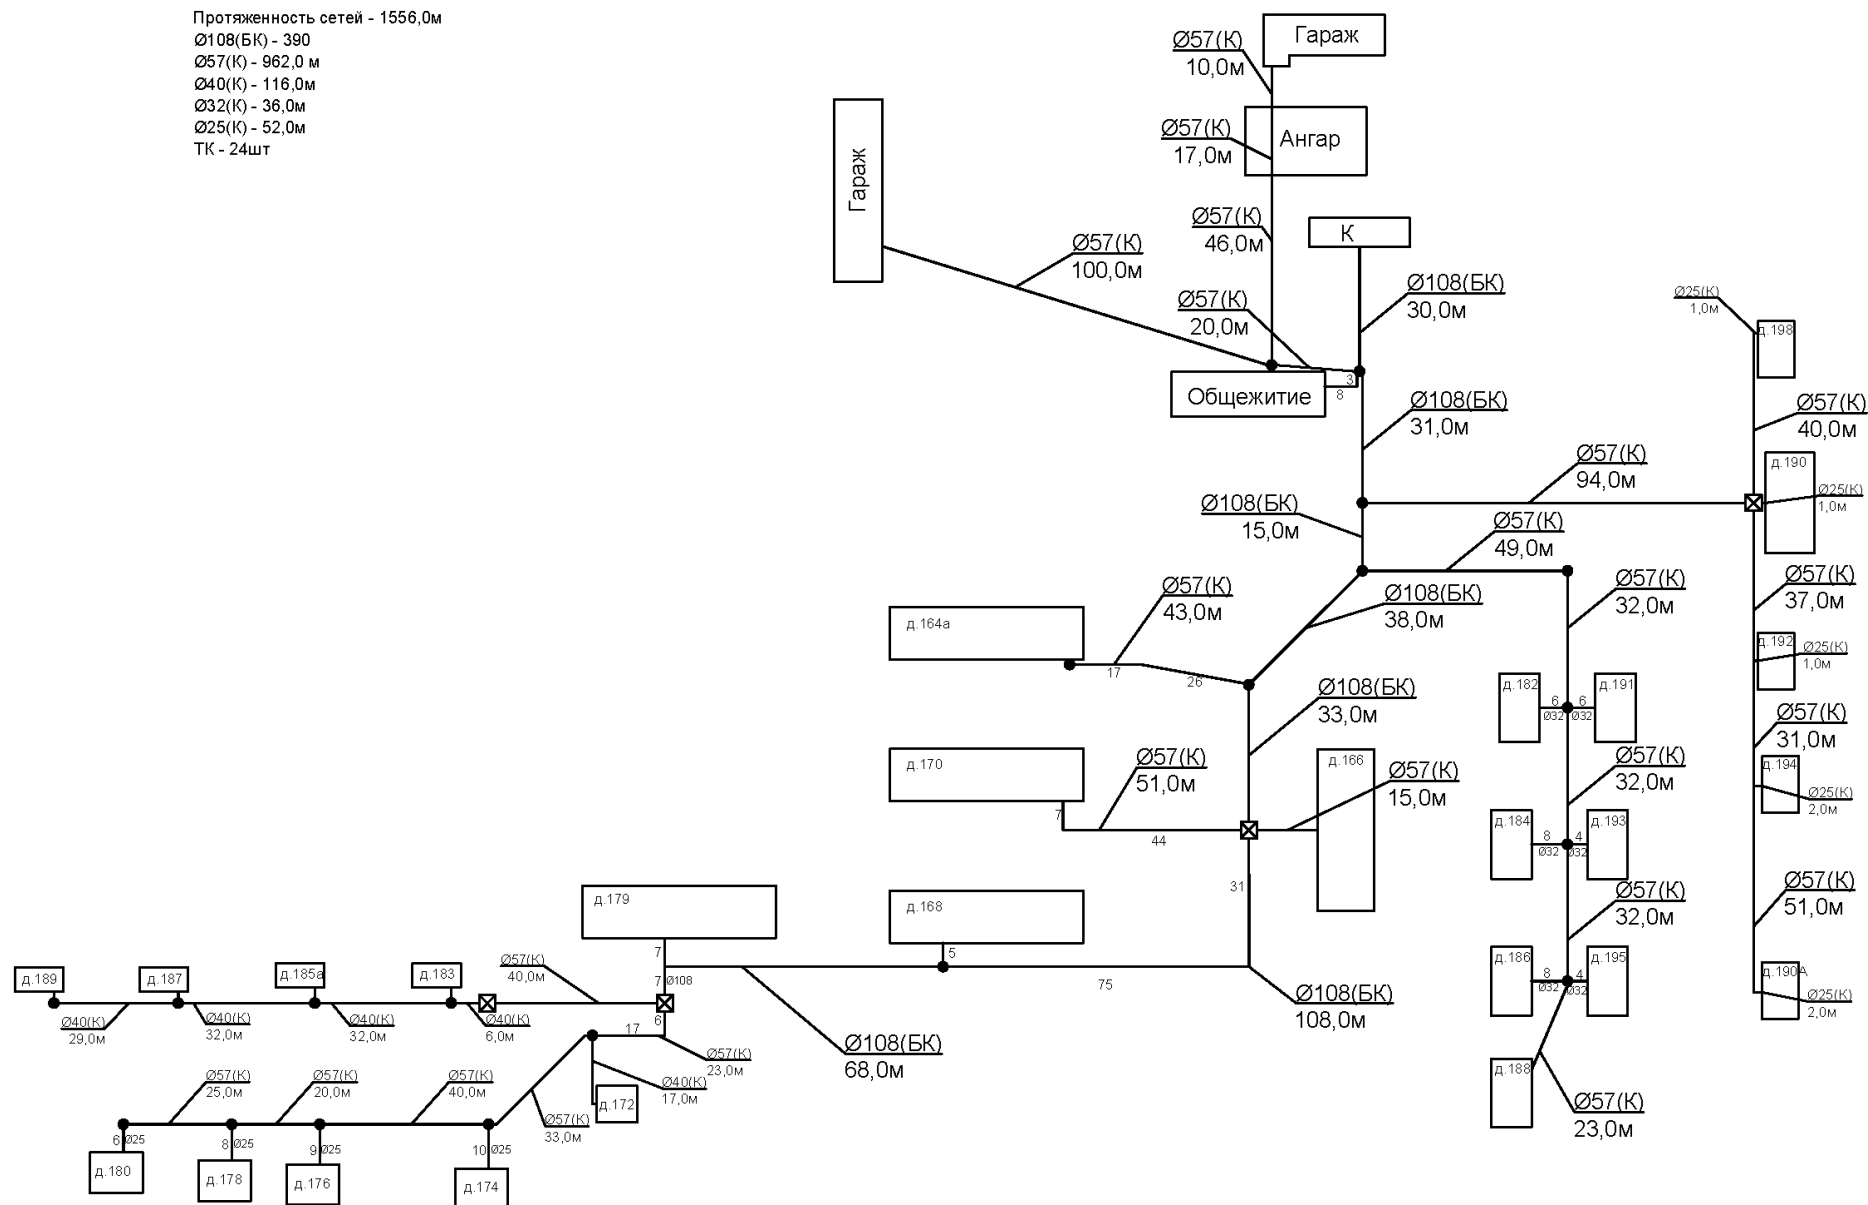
Схема тепловой сети котельной ПМК-1313
